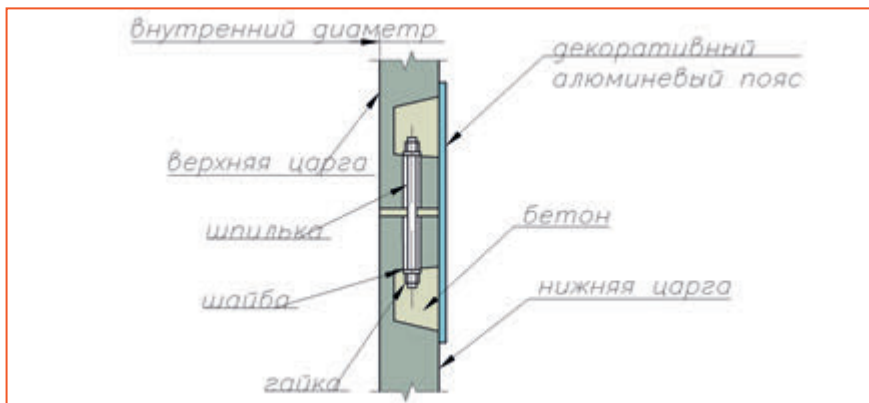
Конструкция стыка царг сборной железобетонной трубы
